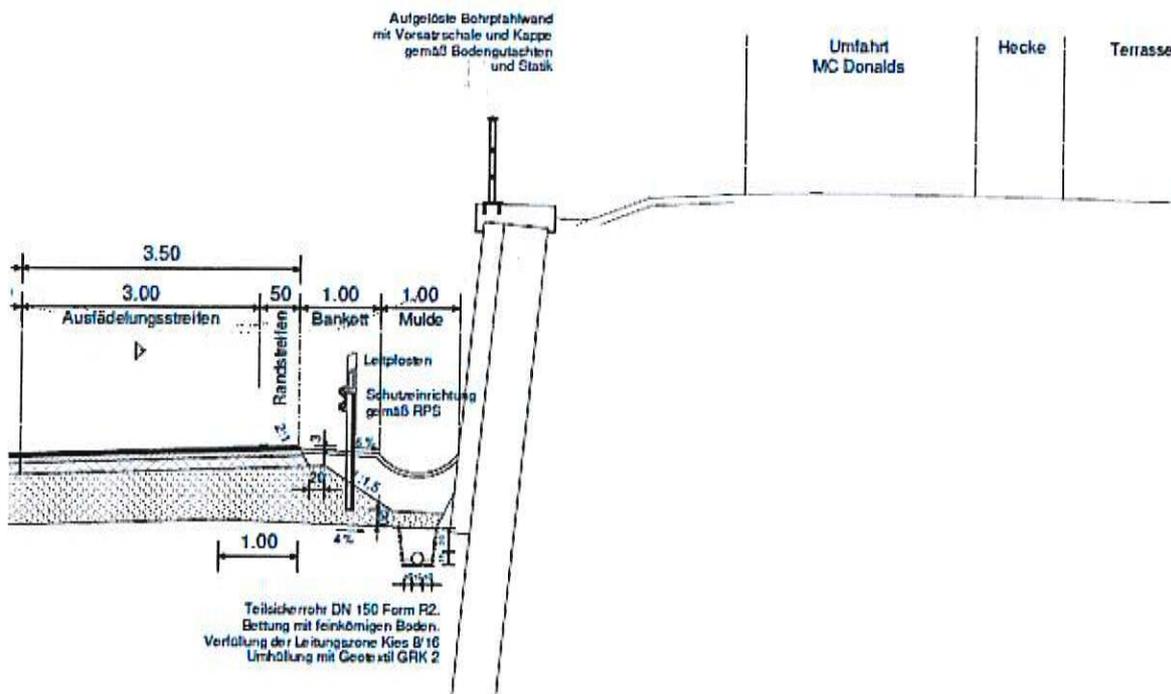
BW 02 / Geländeabstützung zum Schnellrestaurant Ort Haus-Nr. 38
